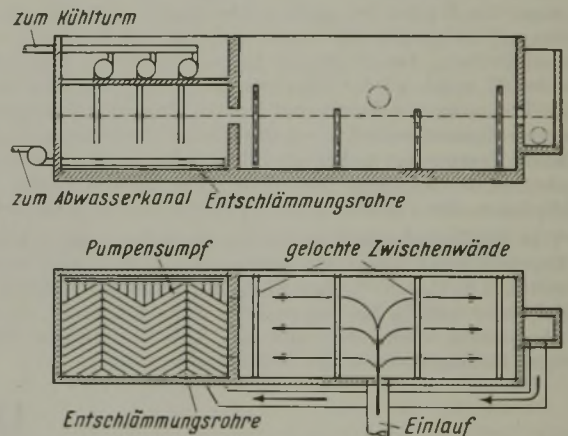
Schnitt und Grundriß durch die Zundergrube.
